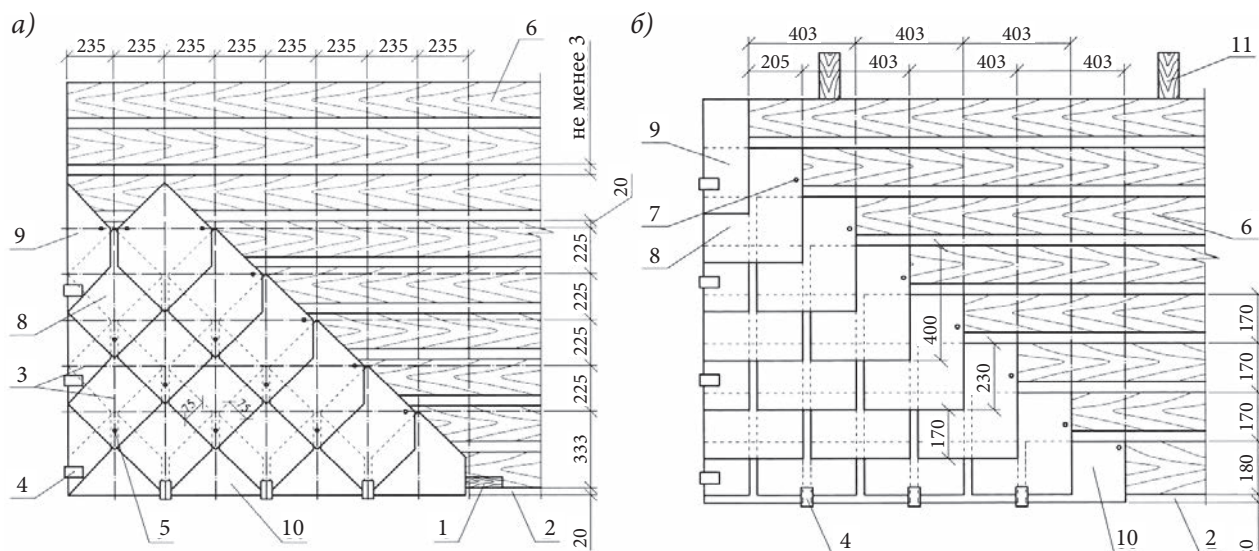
Схема обрезки углов перекрываемой и перекрывающей кромок
